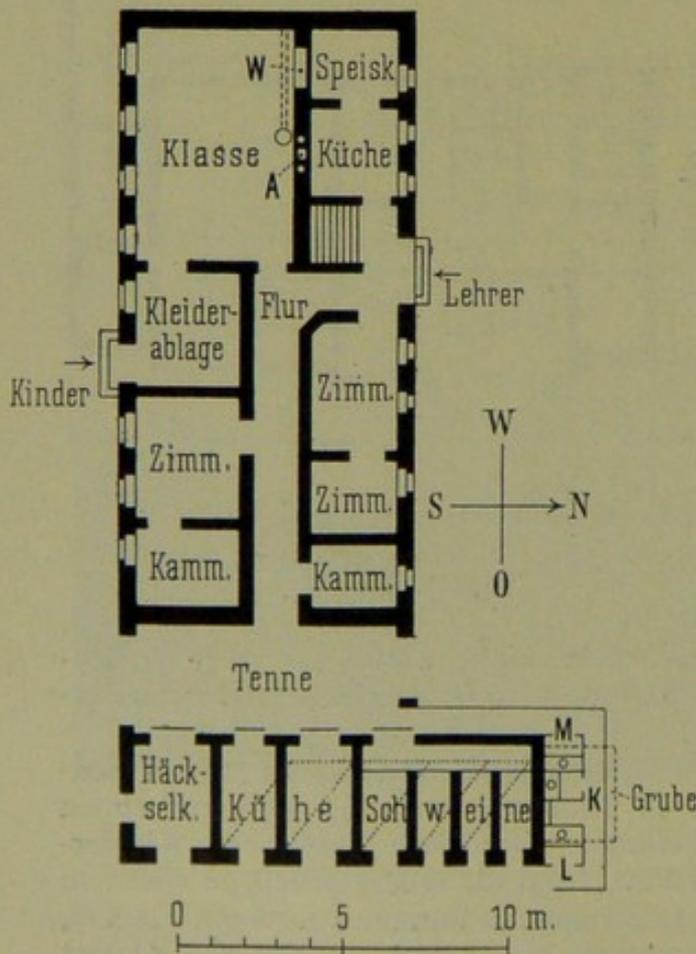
Einklassiges deutsches Landschulhaus mit Lehrerwohnung und Ökonomiegebäuden im Kreise Isenhagen, nach M. LANGERHANS, mit Abänderungen.
